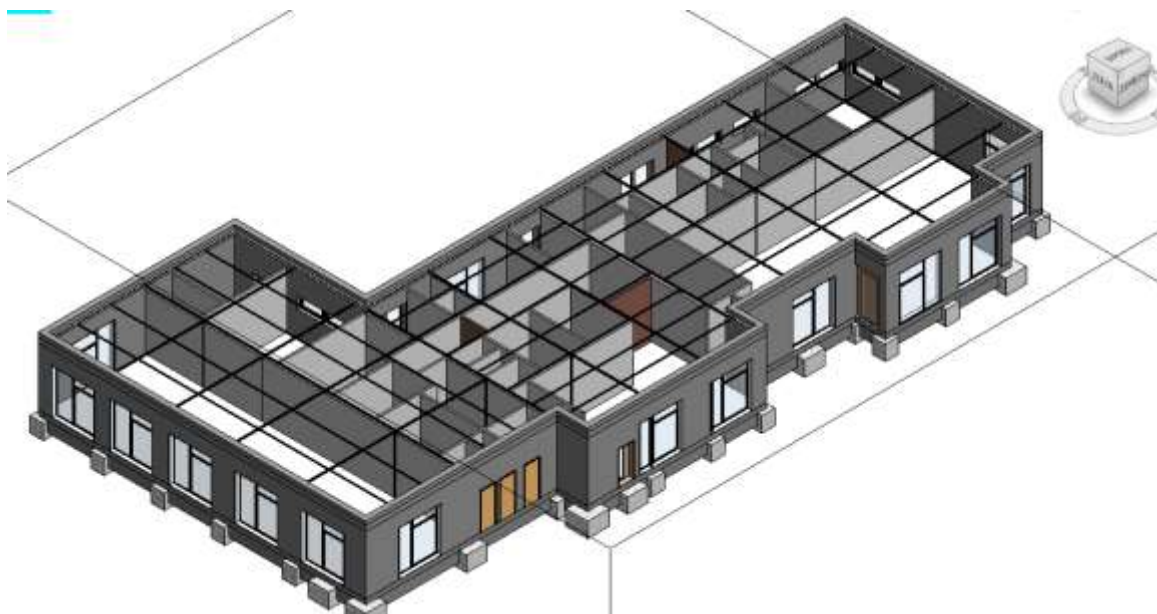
Nosný rám a základové konstrukce [Autor]
